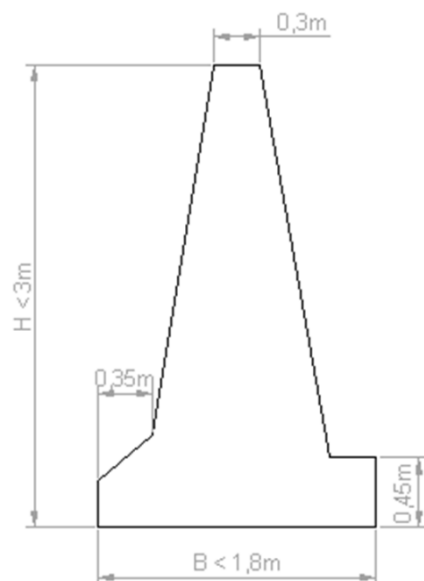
Muro de pedra argamassada (alturas de até 3,0m).
